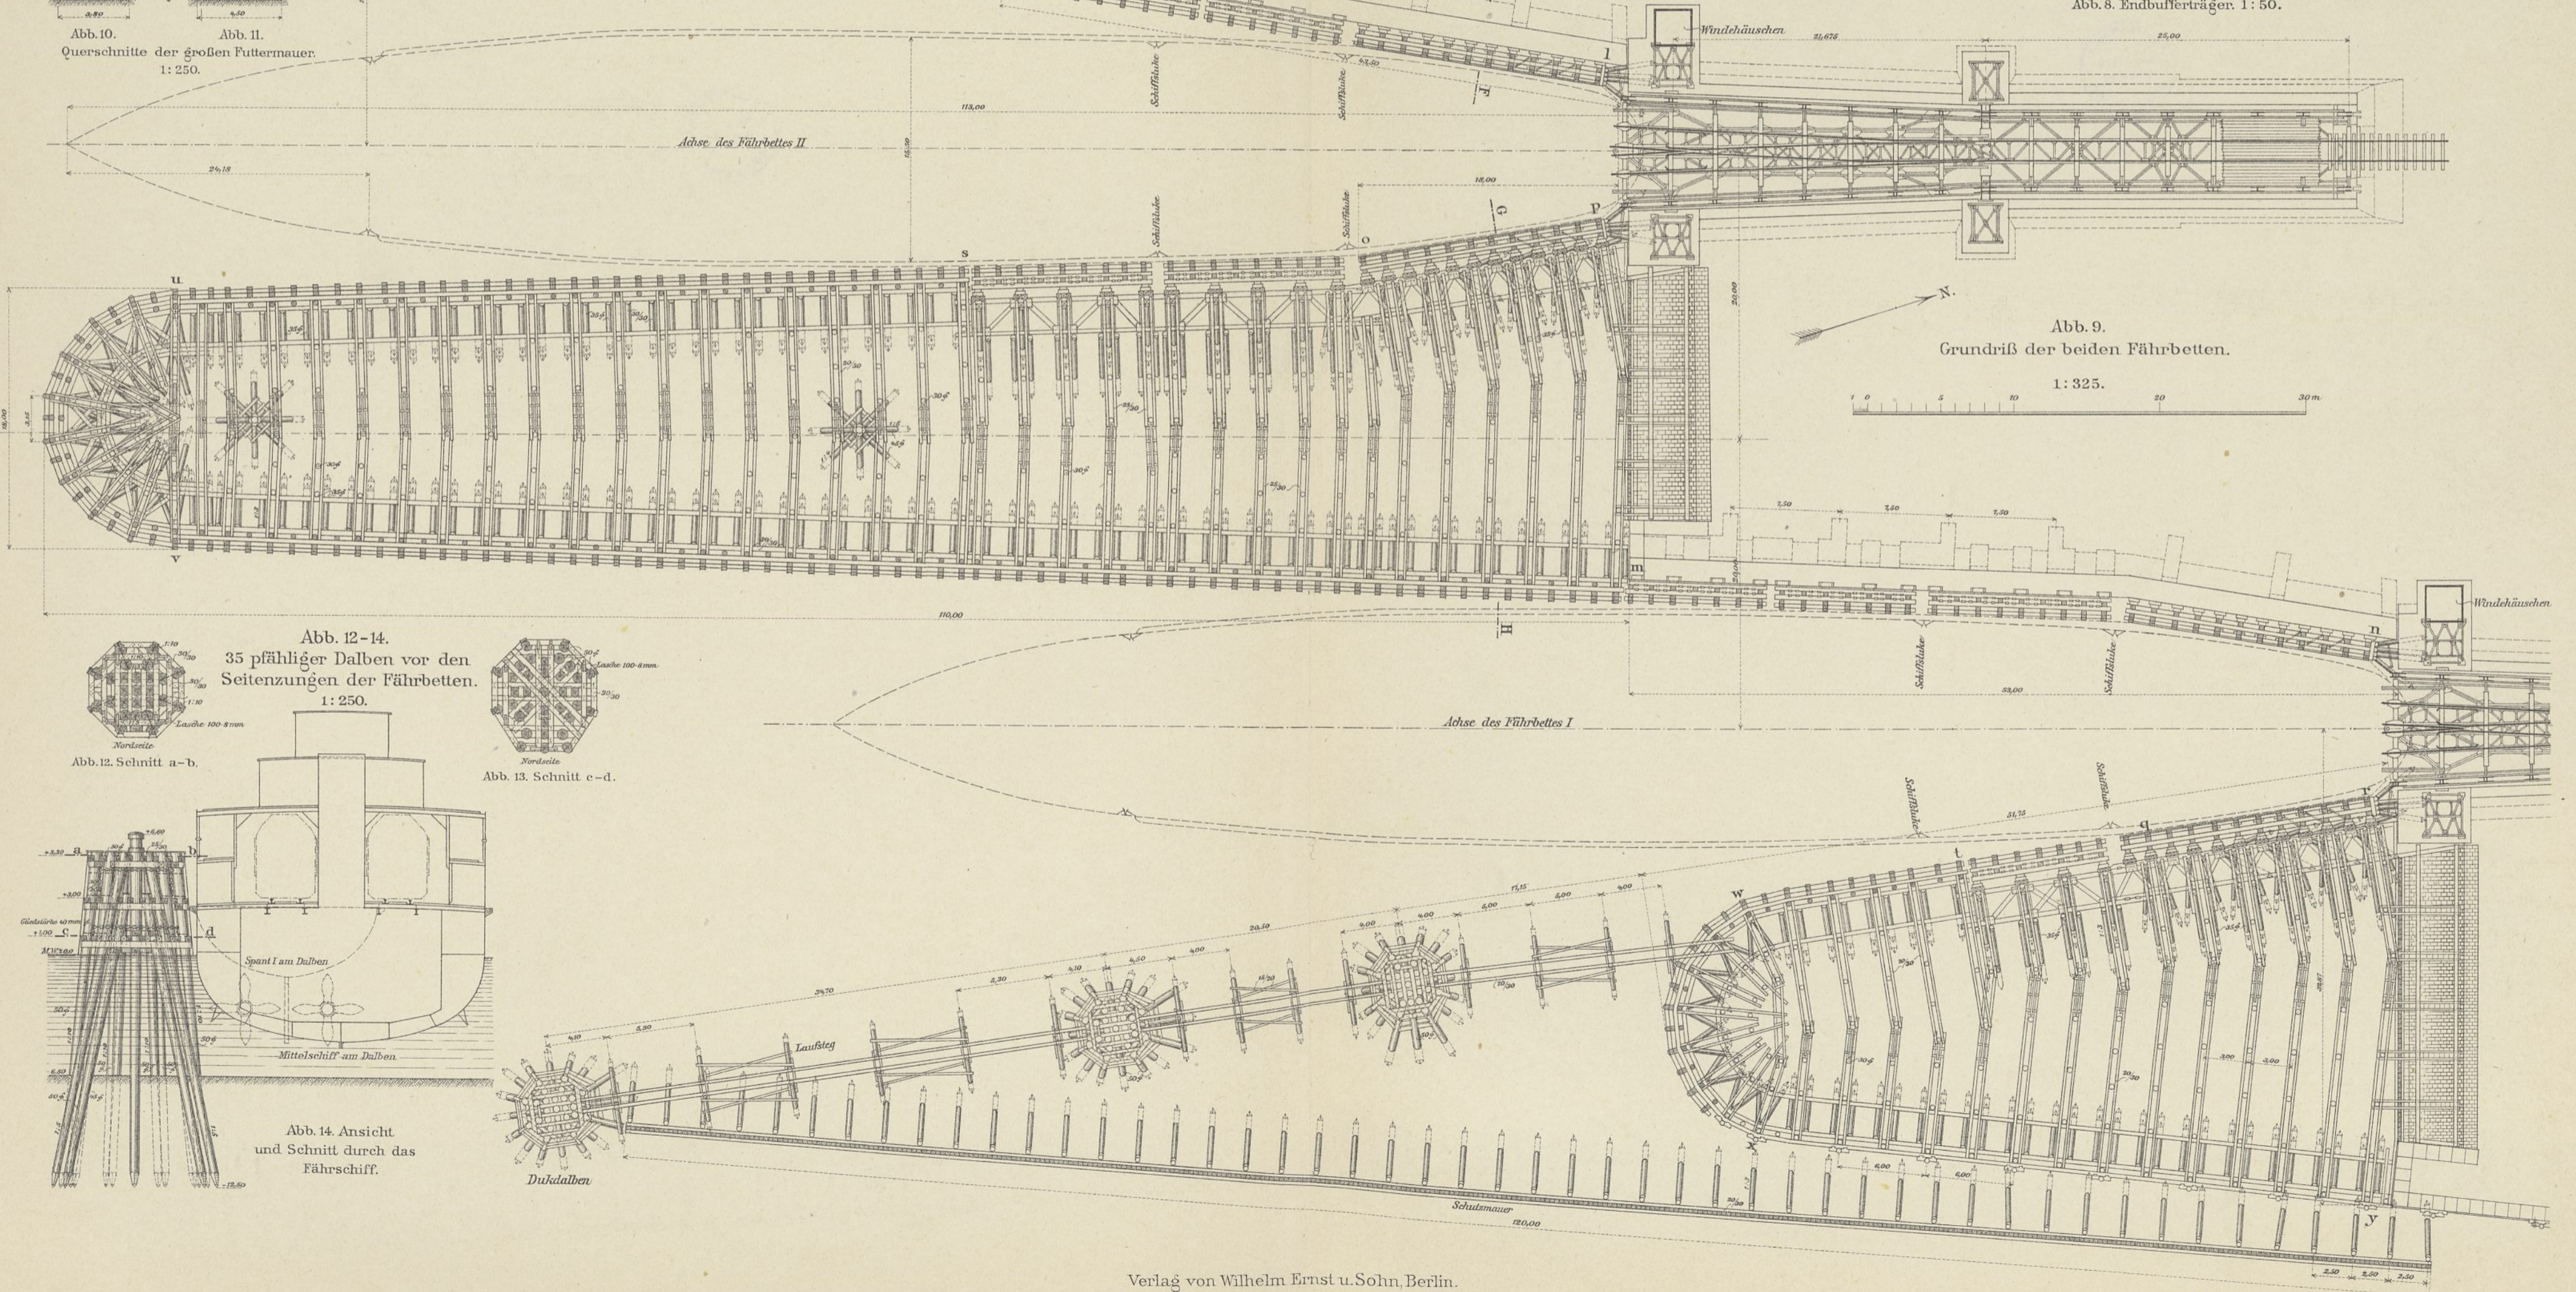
Grundriß der beiden Fährbetten. 1: 325.
